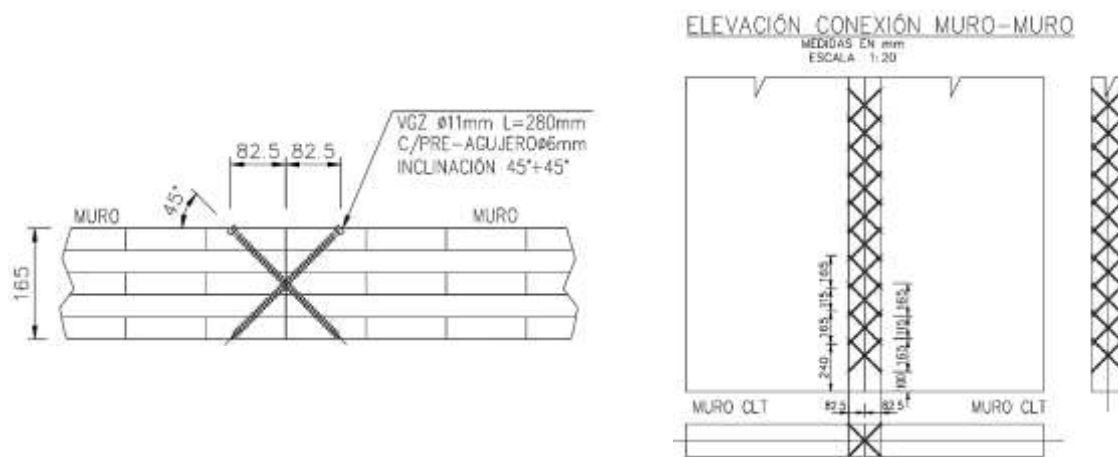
Detalle conexión muro-muro, vista en planta y elevación (mm)
